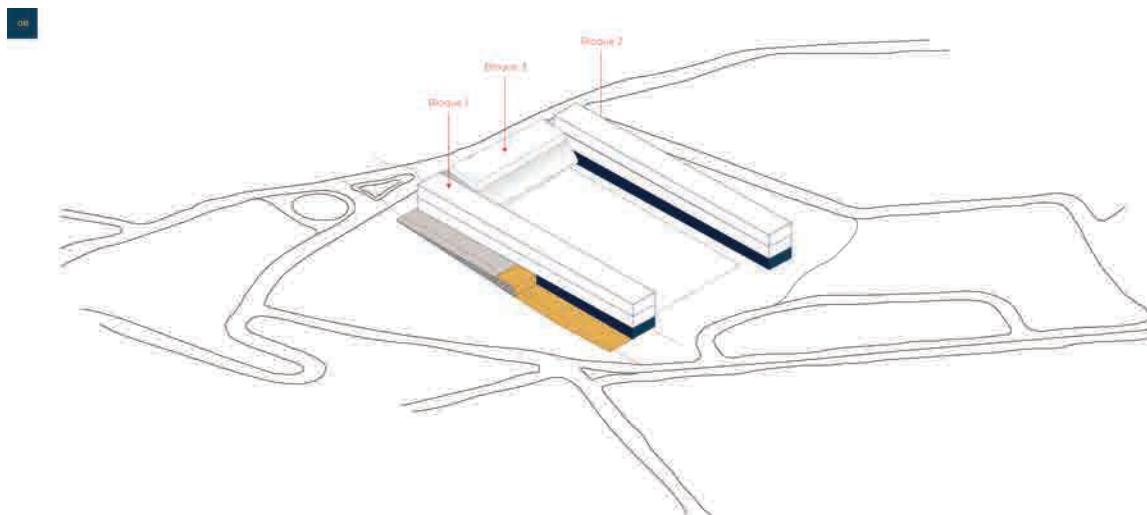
Implantación de bloques. Elaboración: Autores.
